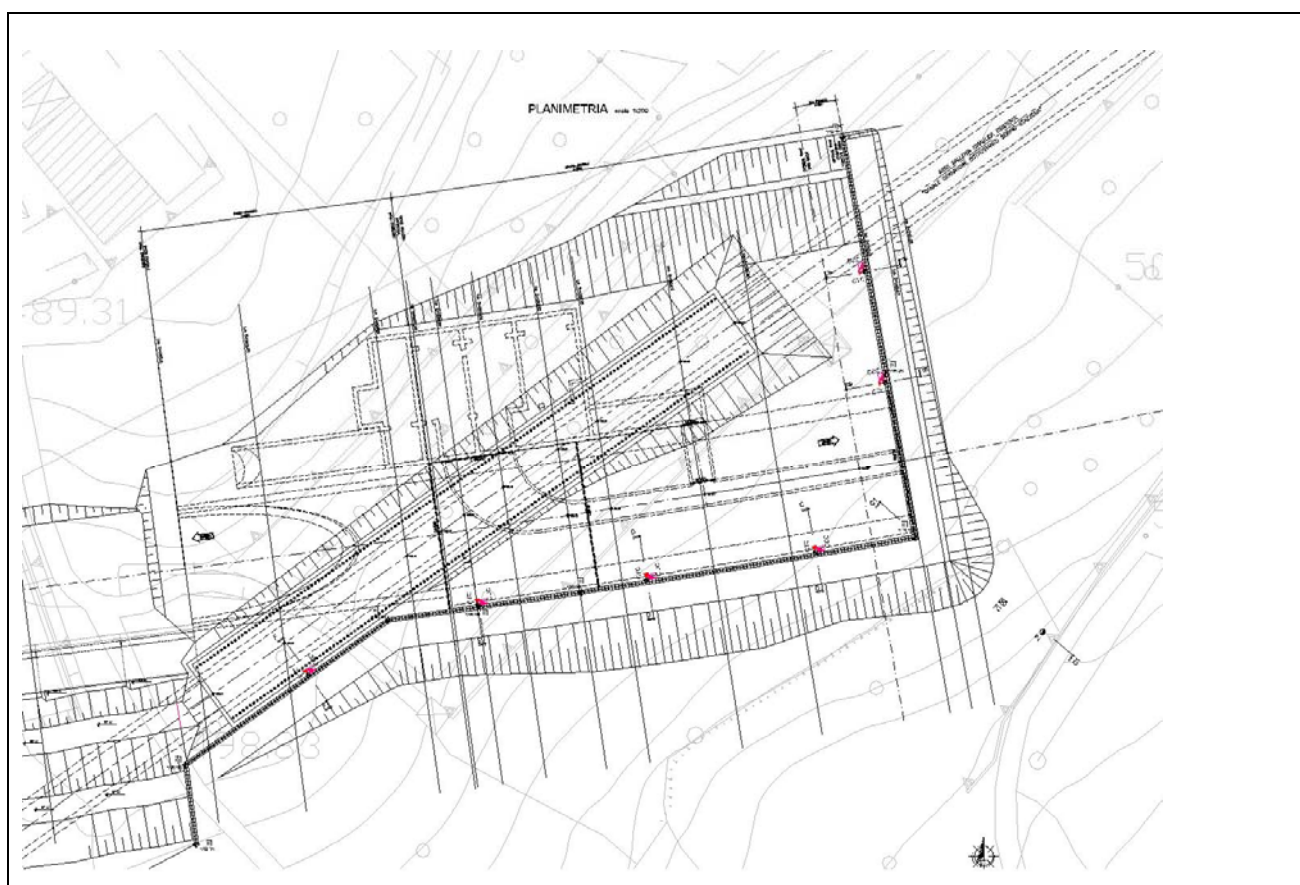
Planimetria Imbocco lato Sondrio-Monitoraggio berlinese
